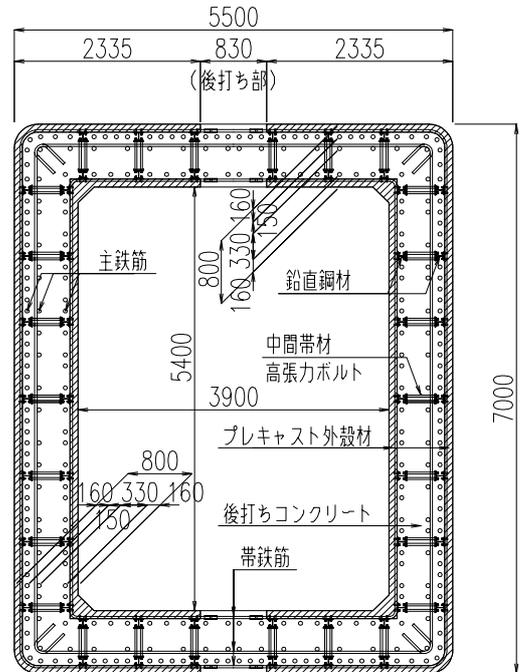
帯鉄筋鉄骨コンクリート合成構造橋脚断面
